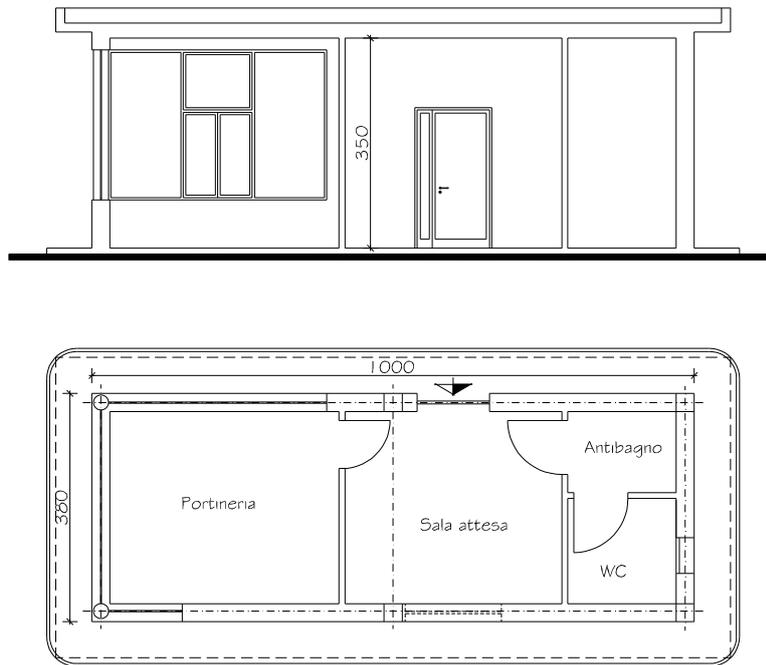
Pianta, sezione e prospetto longitudinale fabbricato D
